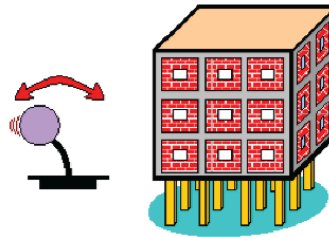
Efeito pêndulo invertido em pórticos de betão armado (Furtado, 2013).
